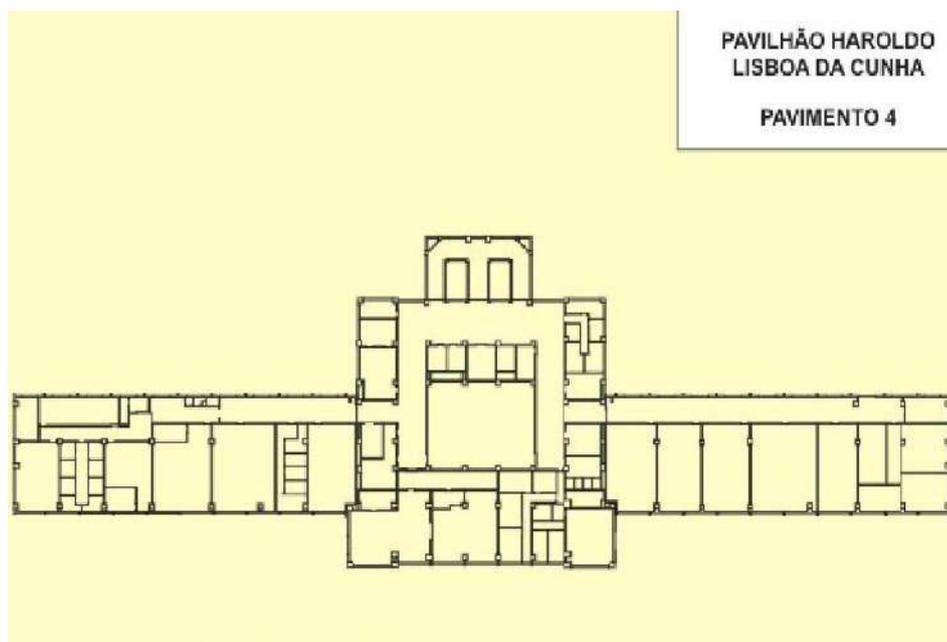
Planta baixa de pavimento do Pavilhão Haroldo Lisboa da Cunha/UERJ
